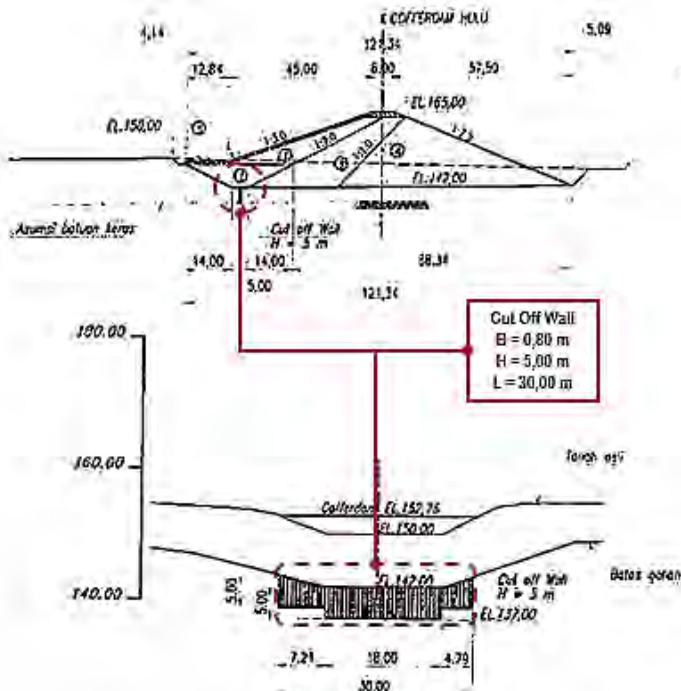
Denah Pekerjaan *Cut Off Wall
